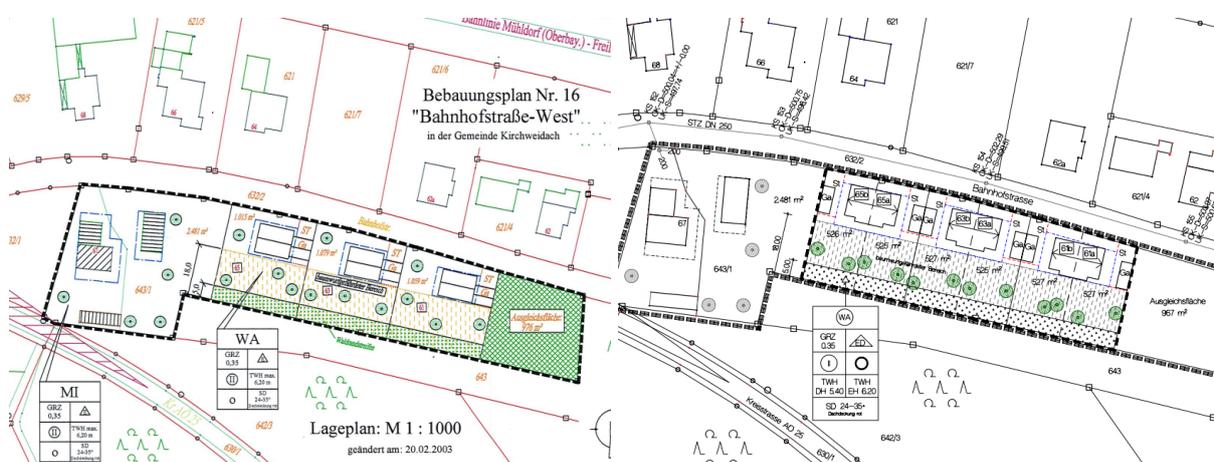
Bebauungsplan Nr. 16 „Bahnhofstraße-West“ aus dem Jahr 2003 (links) bzw. geplante Änderung 2023 (rechts)
